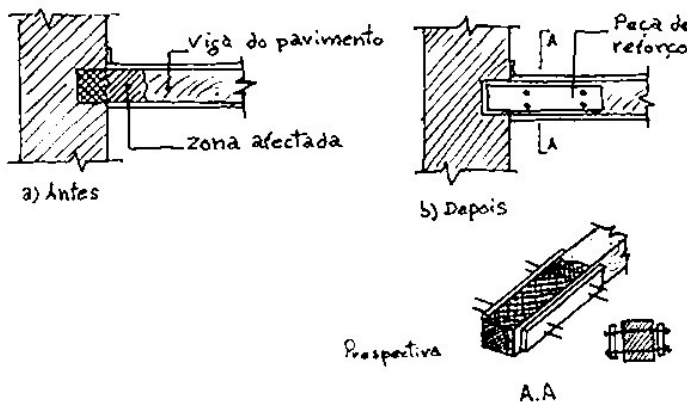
| Esquema de colocação empalme lateral numa viga de madeira
